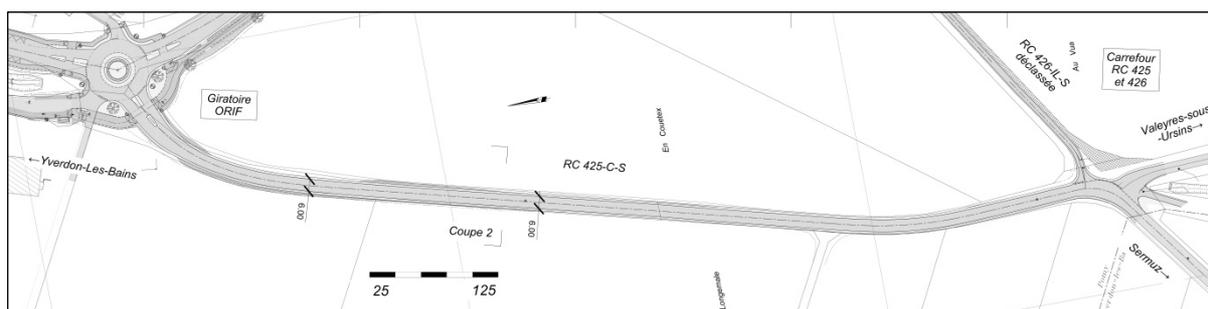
extrait plan de soumission, situation RC 425 (vue 4)
